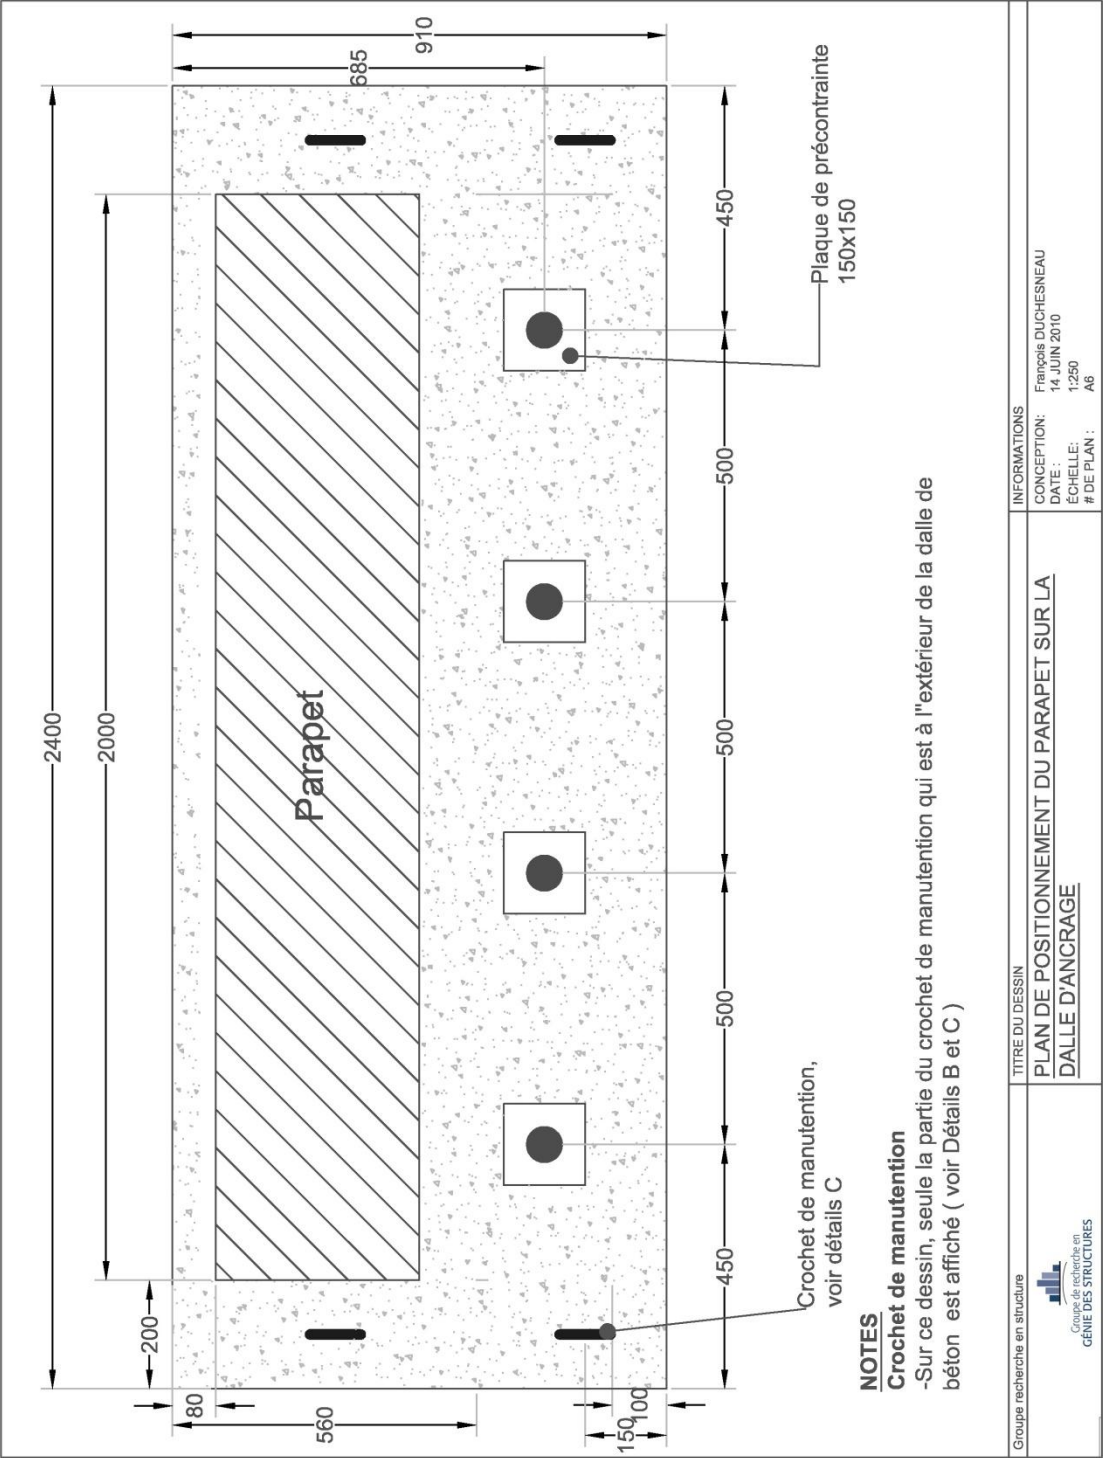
Plan de positionnement du parapet sur la dalle d'ancrage
